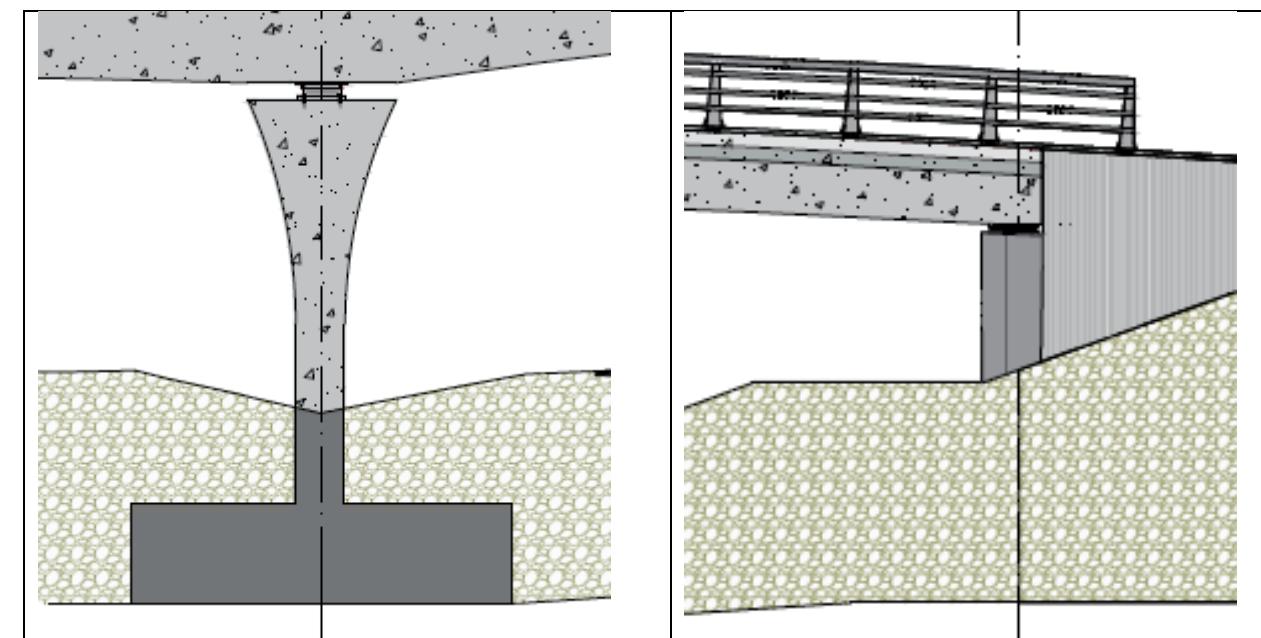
Nivelación del terreno conforme proyecto en apoyo central y estribo derecho.
